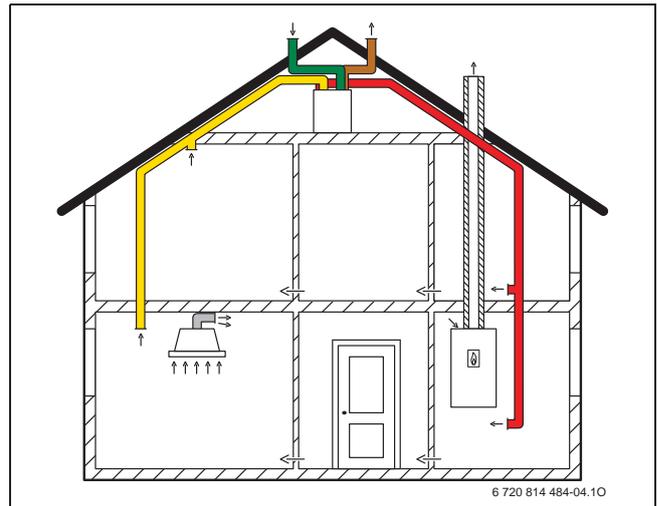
Logavent HRV2- ... e focolare dipendente dall'aria del locale
